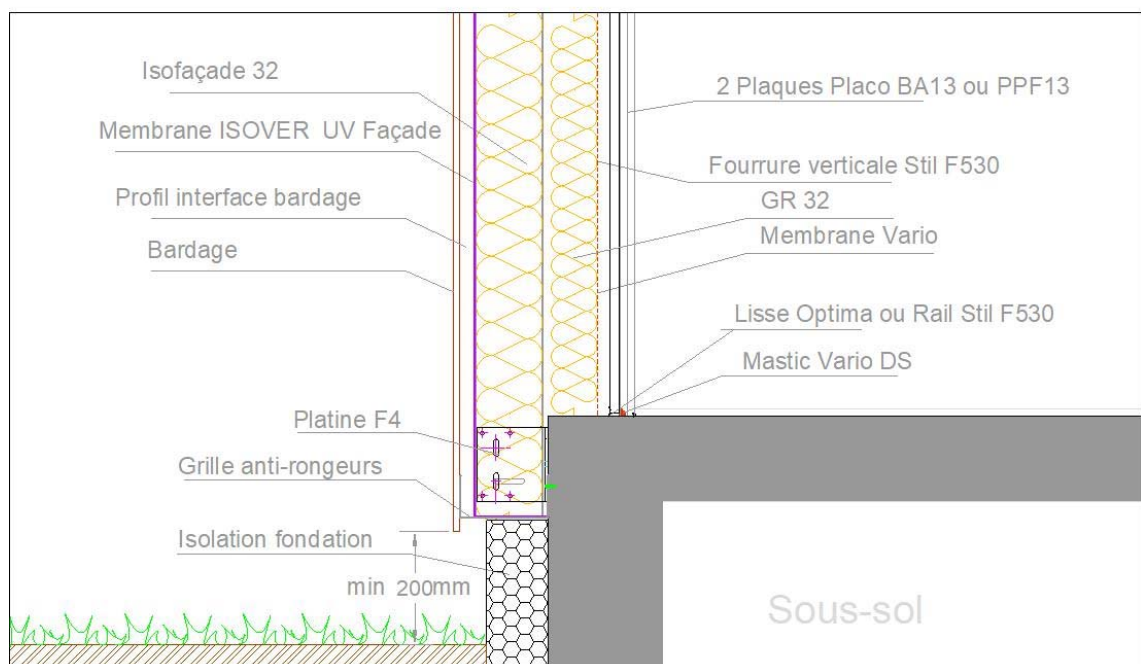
Coupe sur mur de fondation isolé et Pl Ht sous-sol
